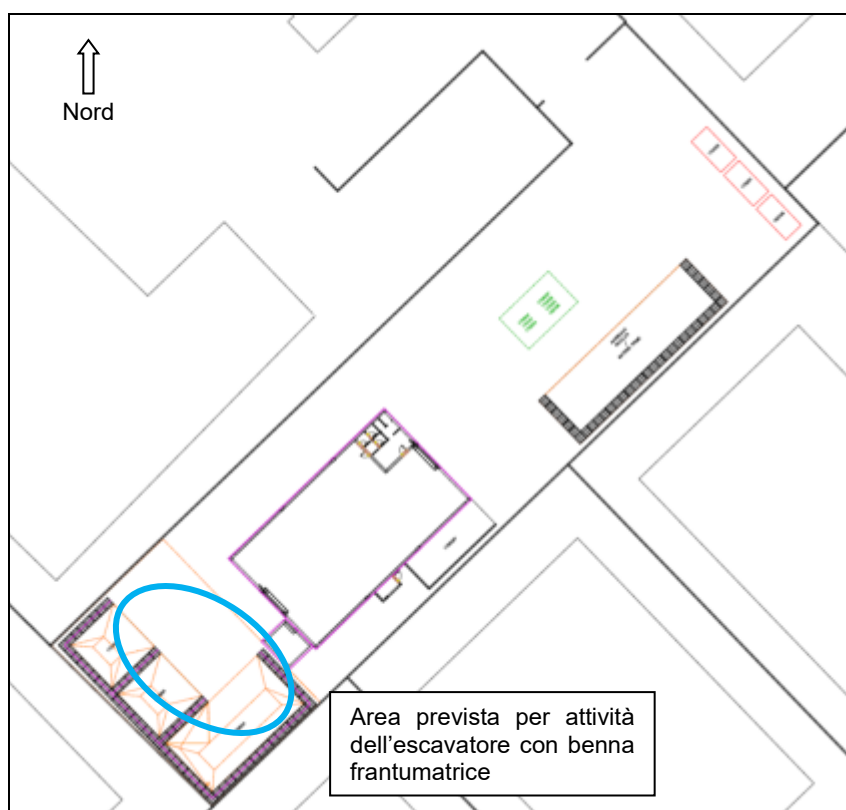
Planimetria del sito in esame con individuazione dell'area prevista per l'attività dell'escavatore con benna frantumatrice
